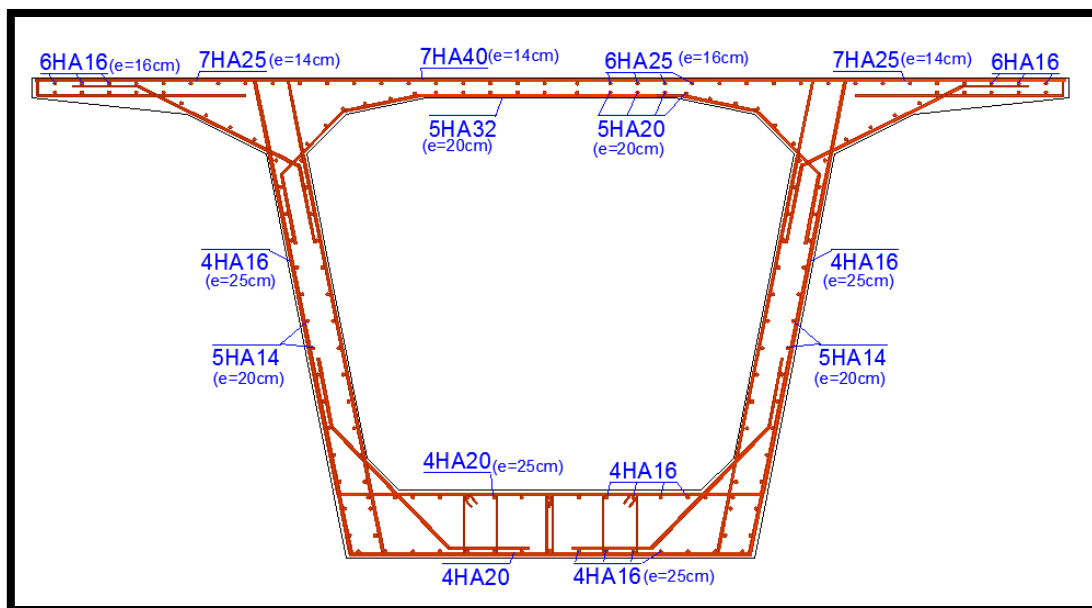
Schéma de Ferrailage du voussoir sur pile
